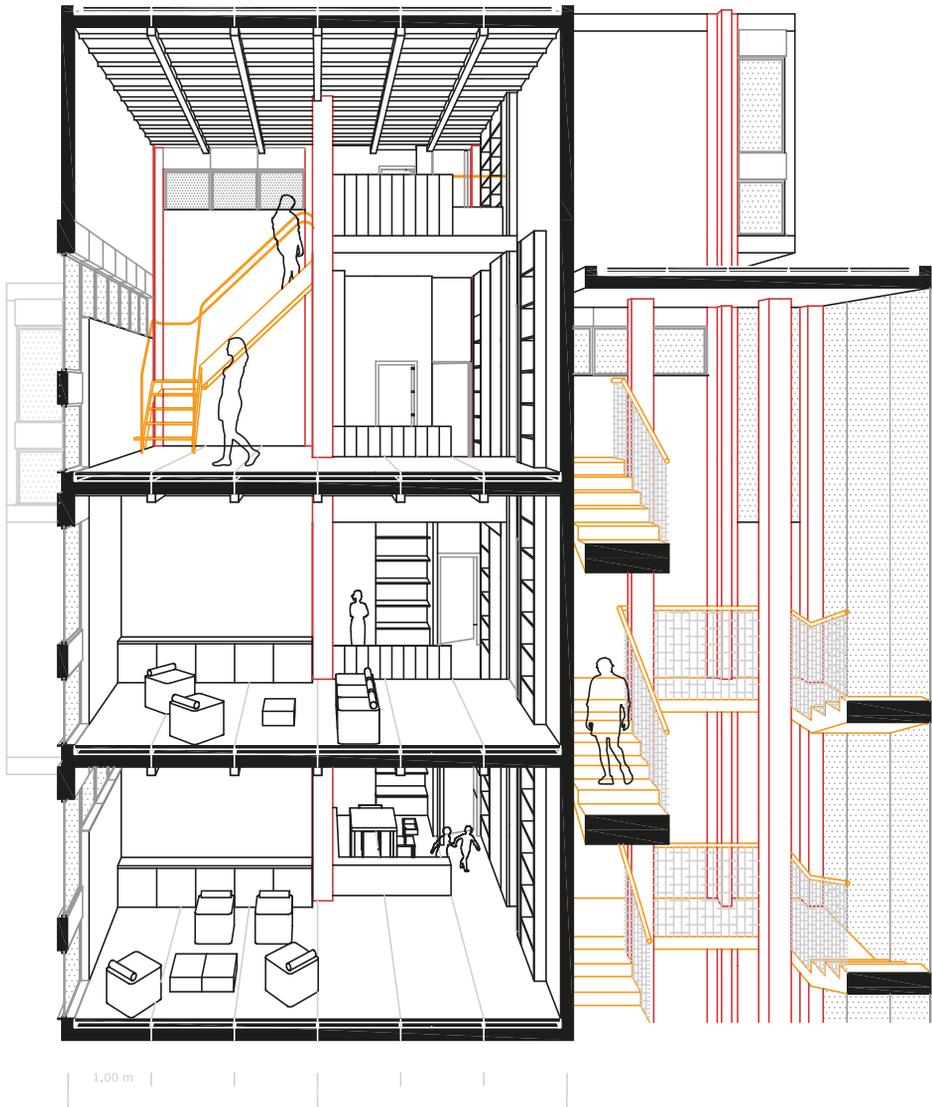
| Sezione prospettica, 2020. Marco Russo
